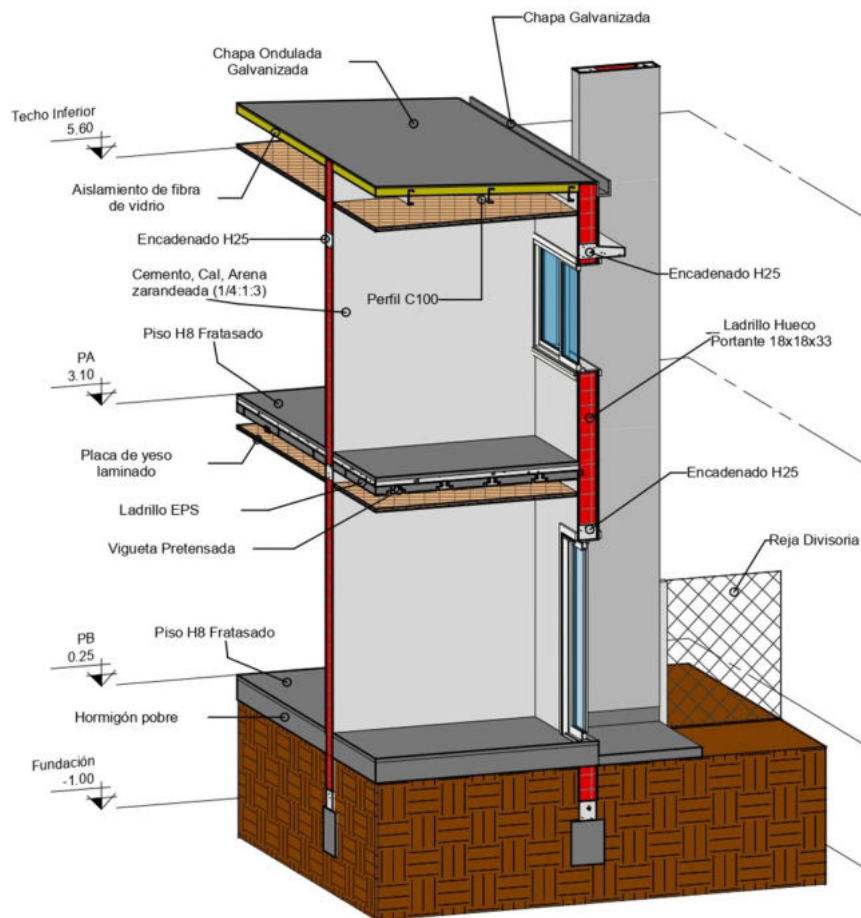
Axonometría seccionada Dúplex prototipo DU 3.6 M. Detalle
